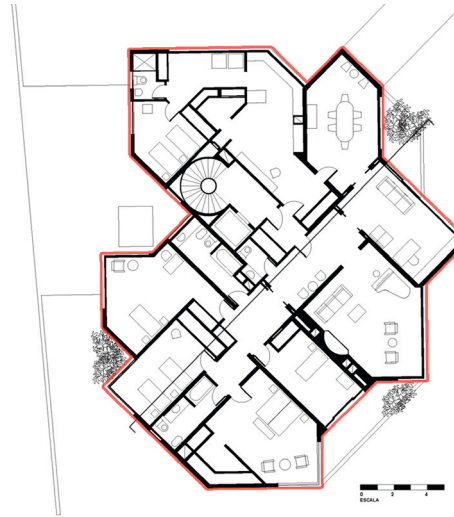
Edificio tipo torre de núcleo central. Fuente: elaboración propia.
